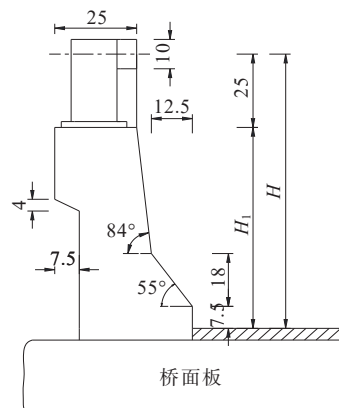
JTG D81—2017规范中组合式混凝土护栏(单位:mm)
